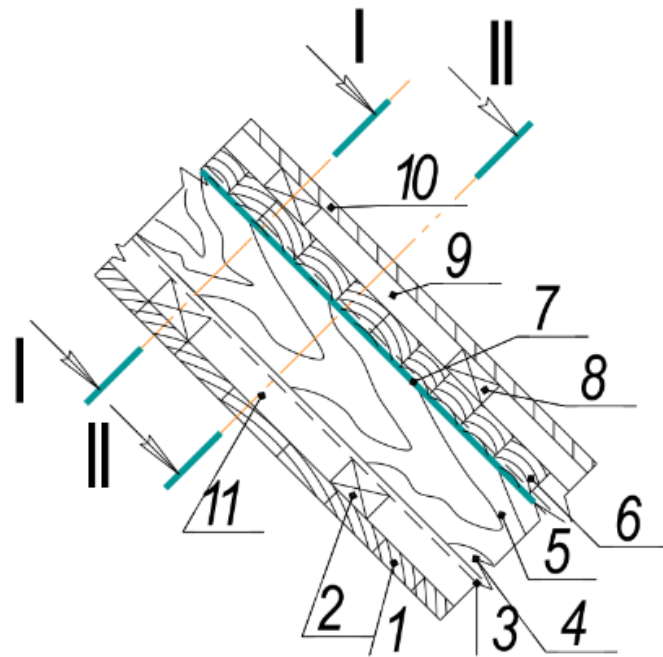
Схема для теплотехнічного розрахунку покрівлі: 1 – підшивна дубова полірована дошка впоперек волокон; 2 – внутрішня обрешітка; 3 – паробар'єр; 4 – утеплювач (мінеральна вата); 5 – кроква; 6 – суцільна опалубка; 7 – гідроізоляція (гідроізоляційний толь); 8 – зовнішня обрешітка; 9 – повітряний прошарок; 10 – сталь покрівельна нержавіюча; 11 – повітряний прошарок.
